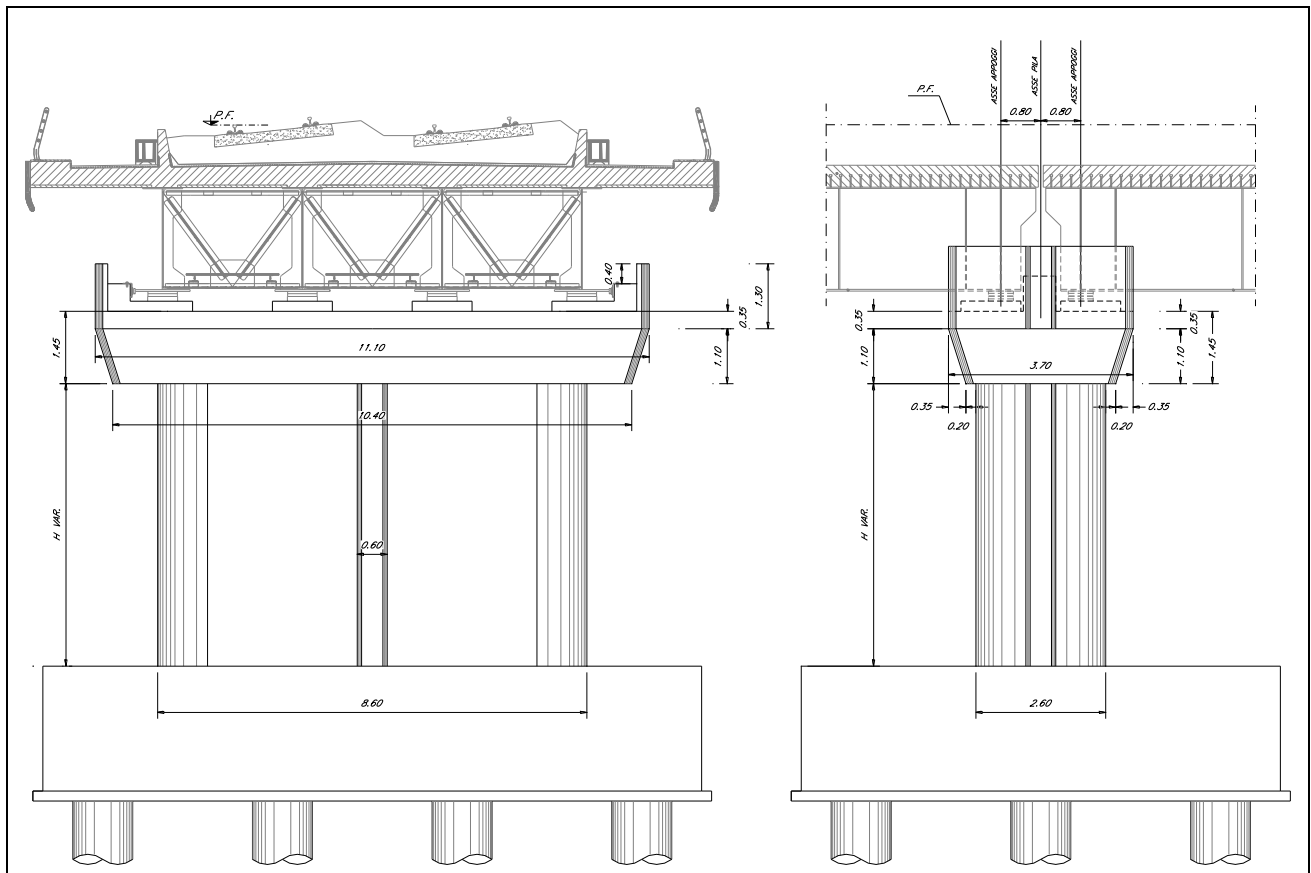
Viste pila tipologica per impalcato L=34.00m
